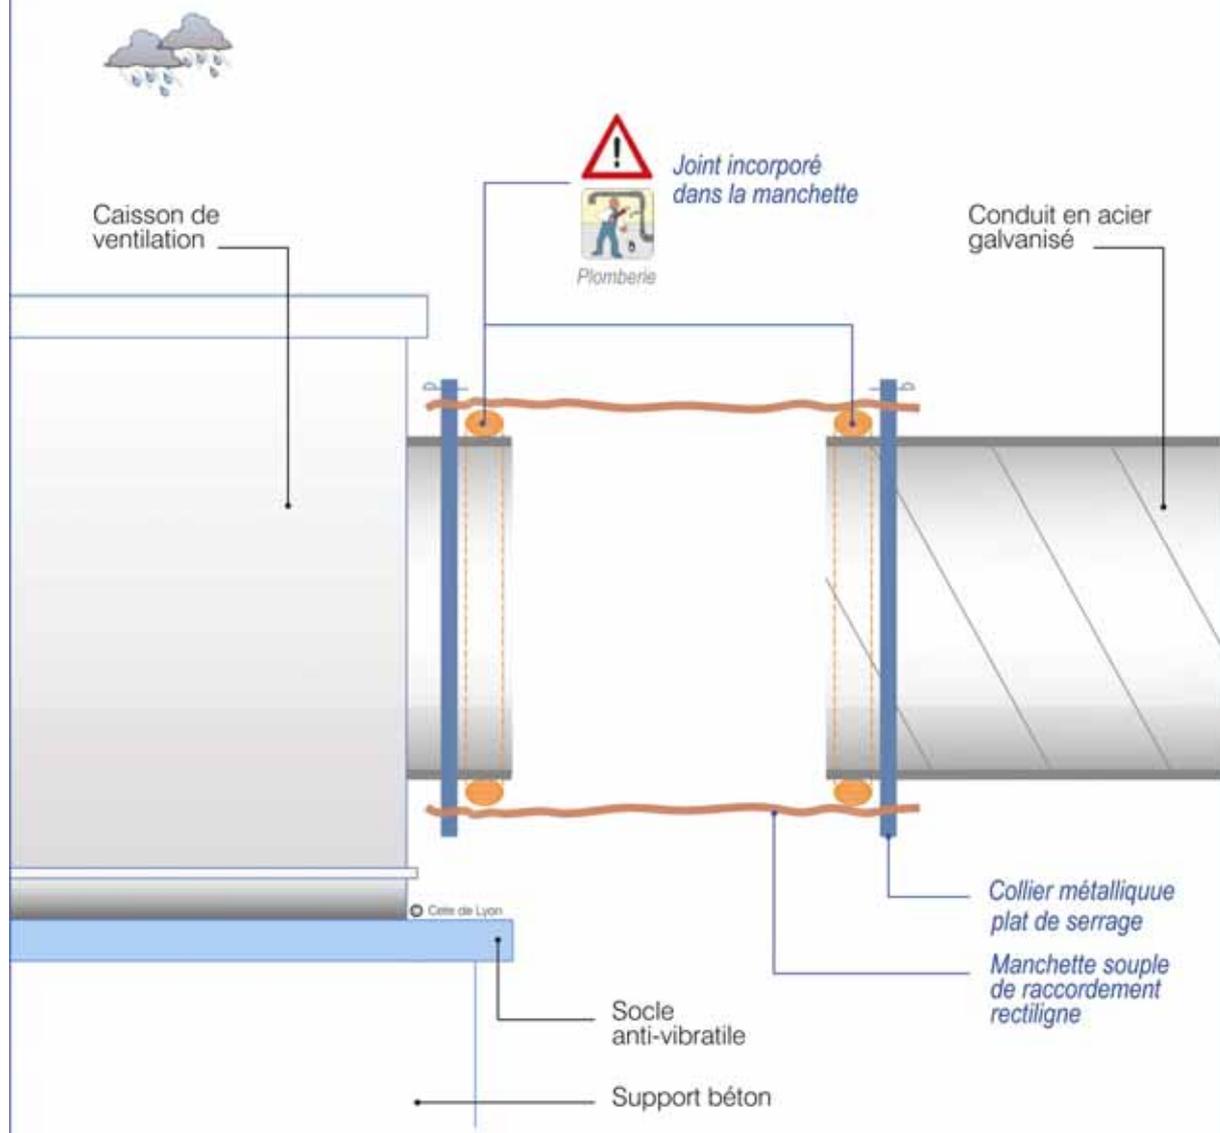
Liaison Caisson de ventilation - Conduit (en toiture terrasse)
